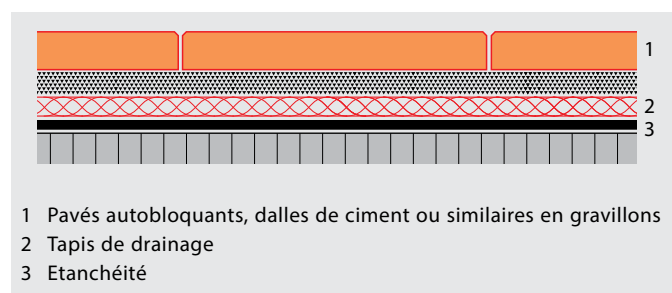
structure d'un système de couche d'usure fermée sur une construction à toit plat isolée thermiquement.
